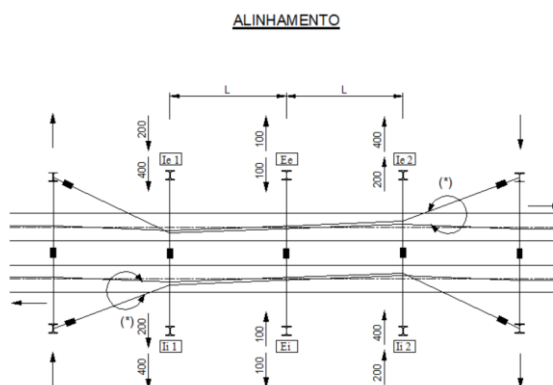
Seccionamento de lâmina de ar com pórticos – piquetagem em alinhamento reto
